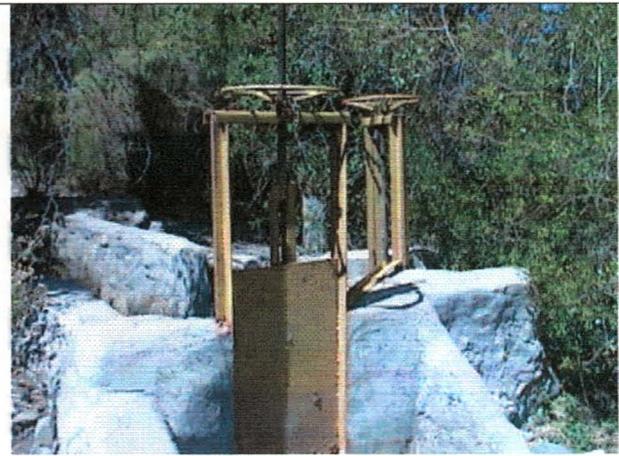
Compuerta de Entrega Tranque Soc.Agr. Y Gan. El Sobrante
